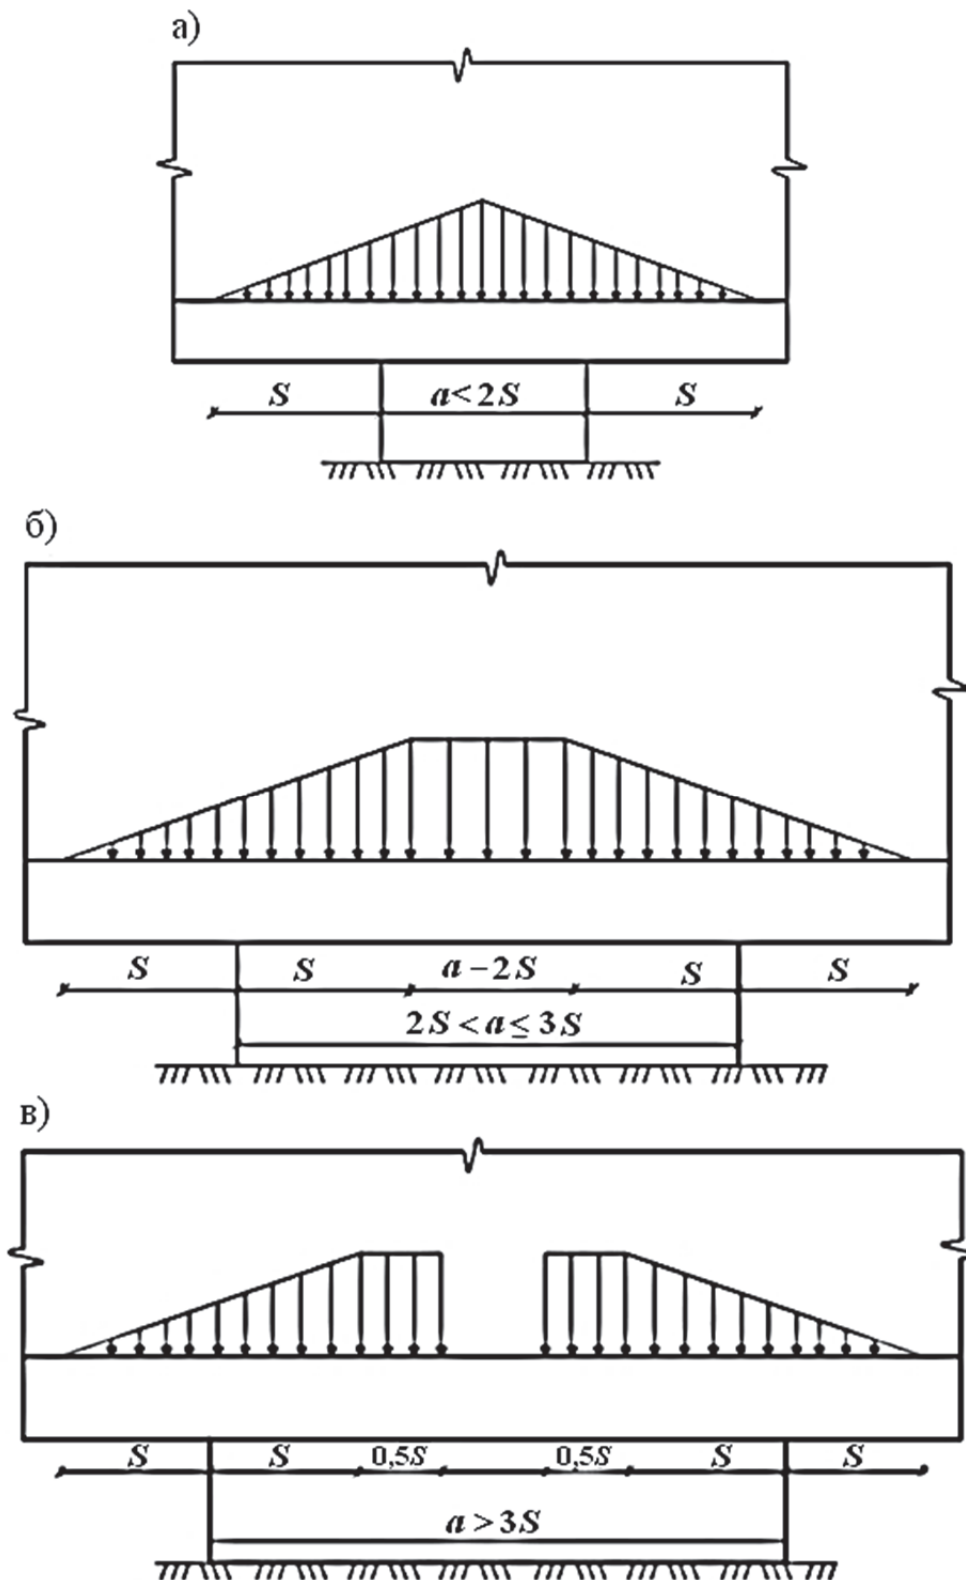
Нагрузка на неразрезные фундаментные балки от стен при ширине столбов: а – $a < 2S$; б – $2S < a \leq 3S$; в – $a > 3S$
